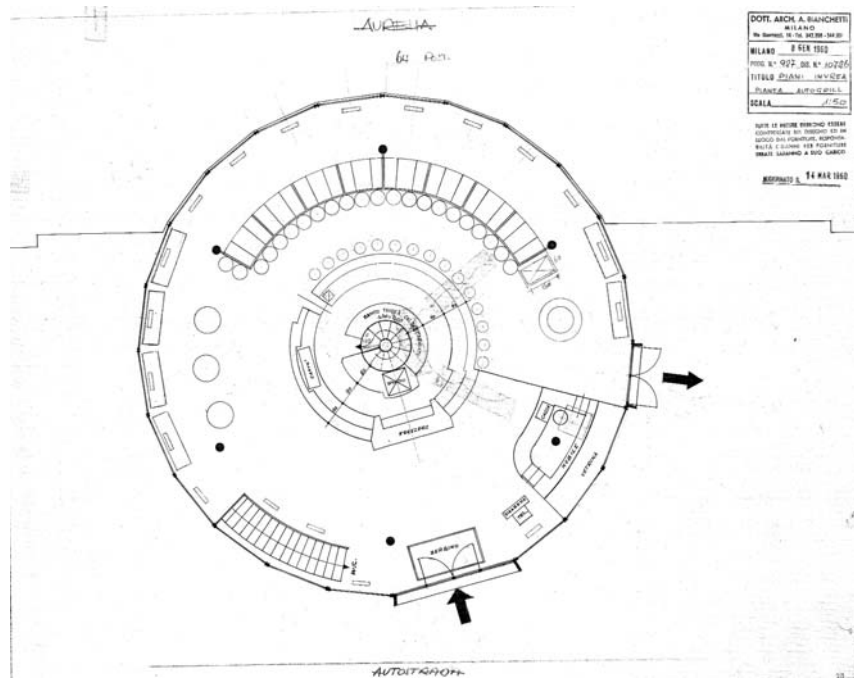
Pianta del piano terra (livello autostrada) (AAB)
